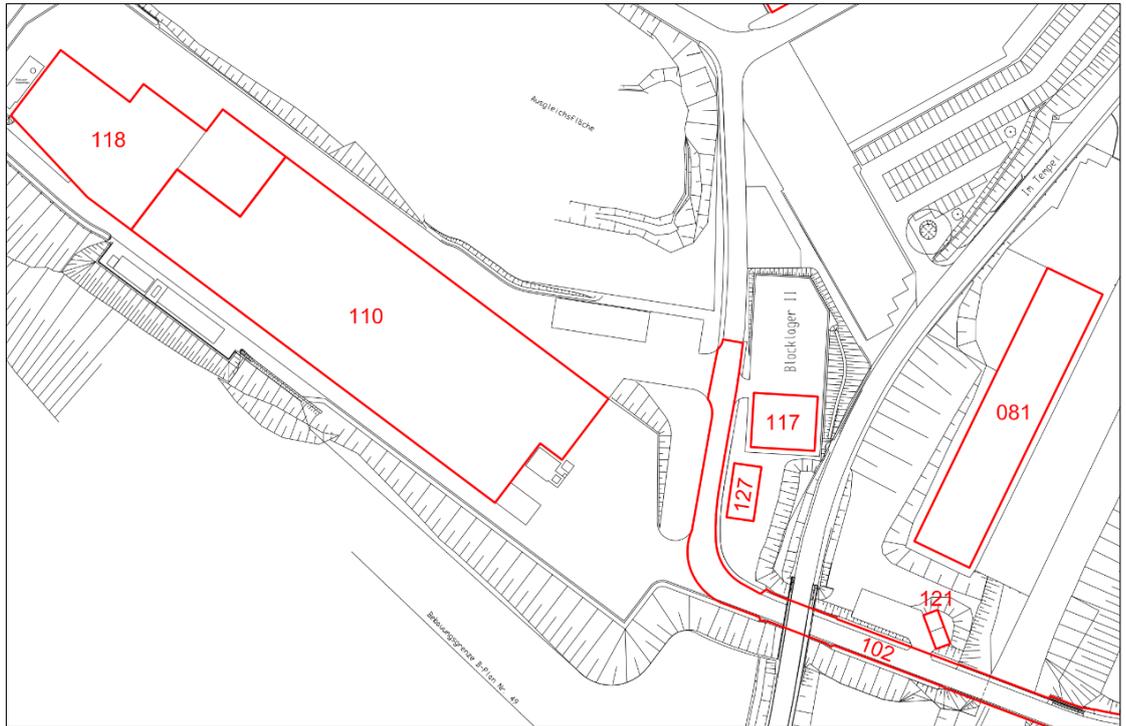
Auszug des Lageplans der OTTO FUCHS KG mit Kennzeichnung der Gebäudenummern Bereich NG4 [73]
